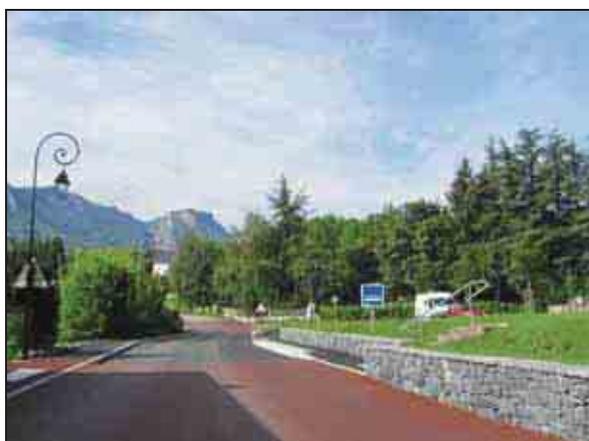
Arrivée sur le chef-lieu depuis les Fourches
